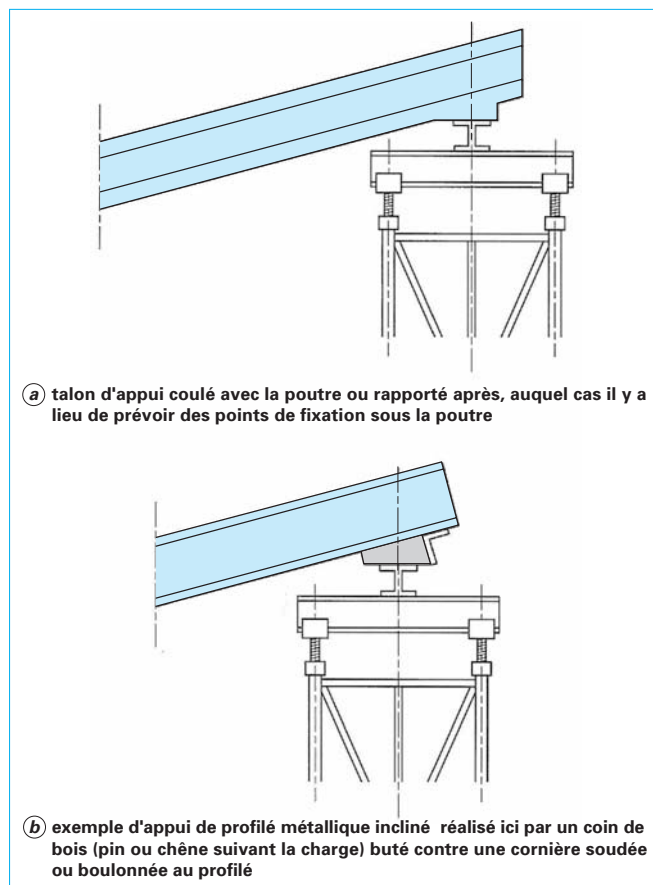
Appui provisoire d'élément incliné (poutre, dalle...) en béton préfabriqué ou profilé métallique
